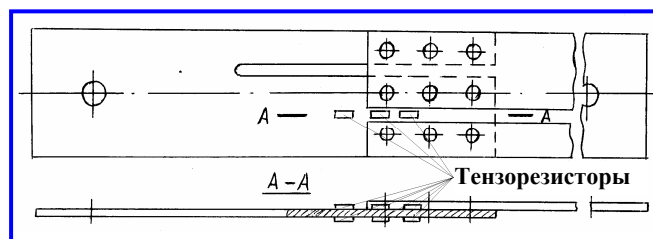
Схема образца соединения листов внахлест с продольными прорезями для тензорезисторов
